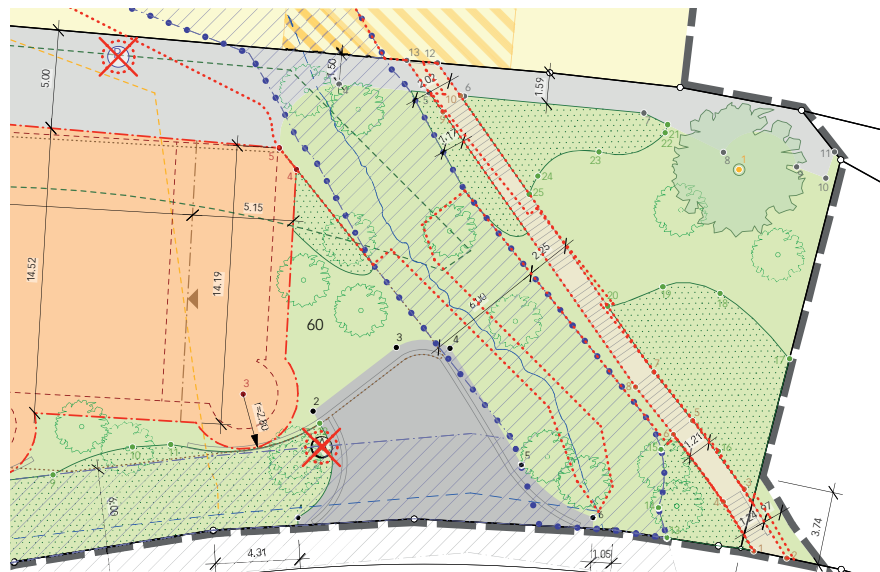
Überbauungsplan Stand 2. öffentliche Auflage (November 2025) mit Änderungen gegenüber der Version Beschlussfassung
